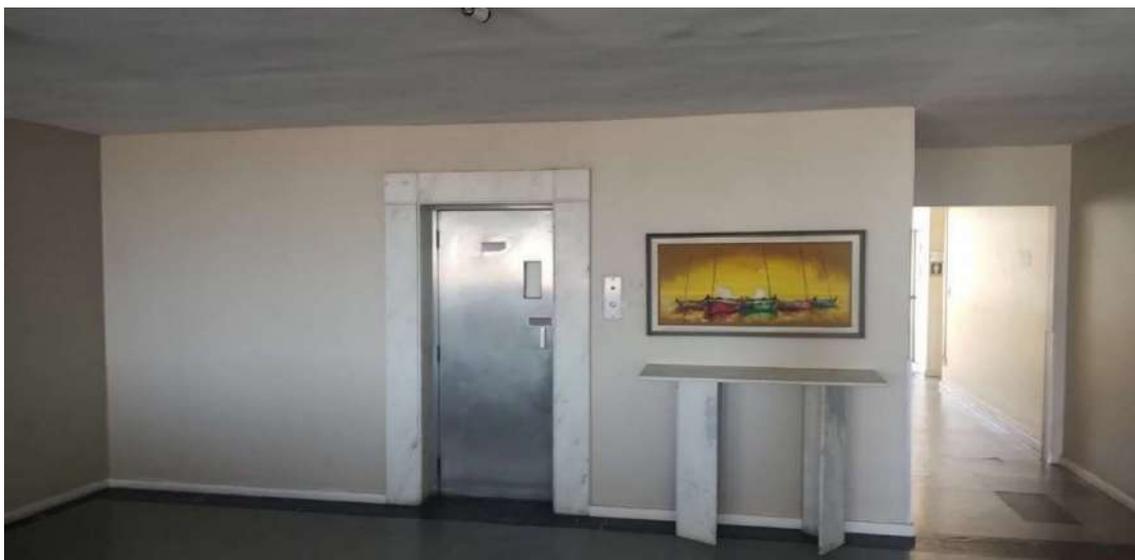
Hall de acesso de entrada do elevador. Porta em aço escovado
